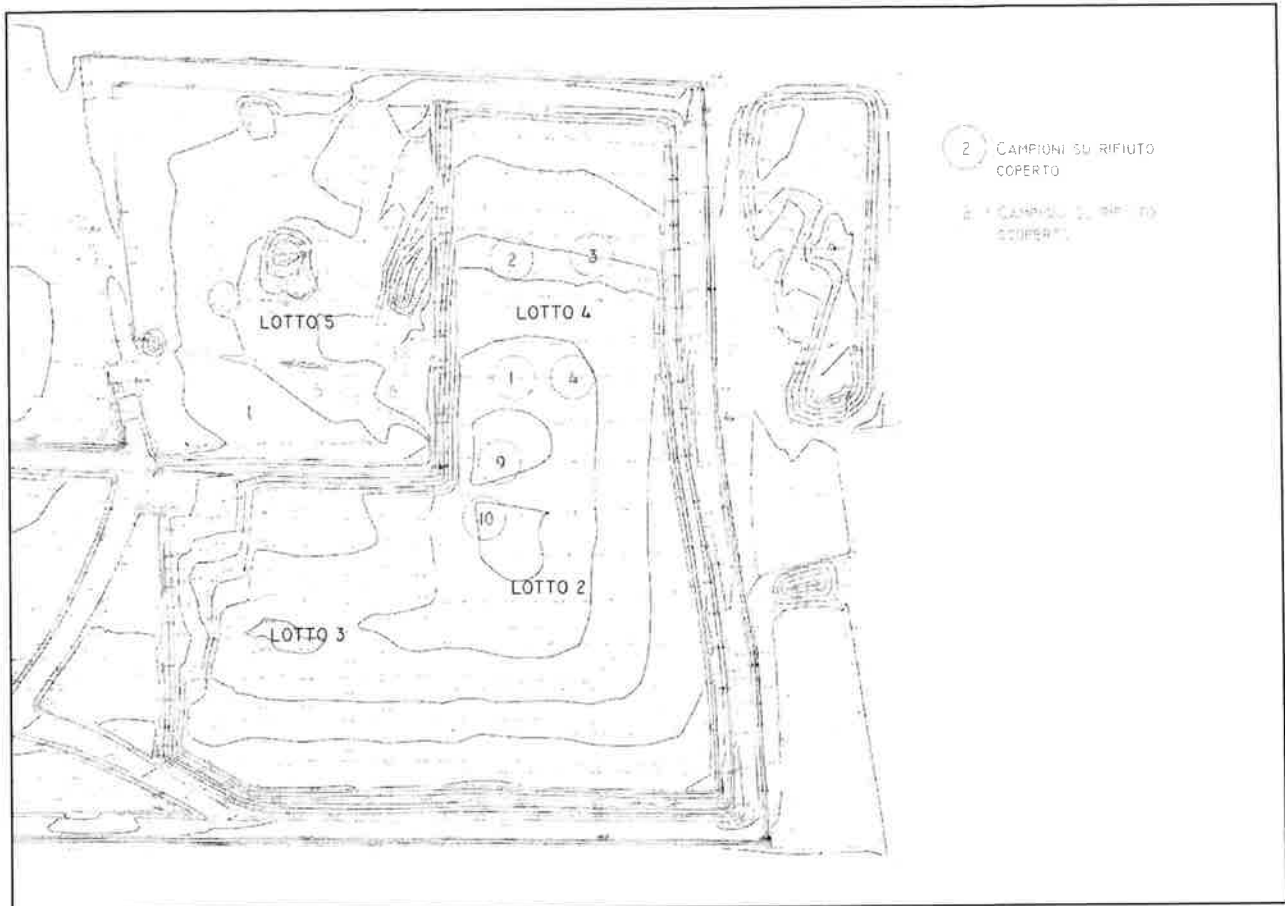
Posizione dei campioni di rifiuto prelevati.
